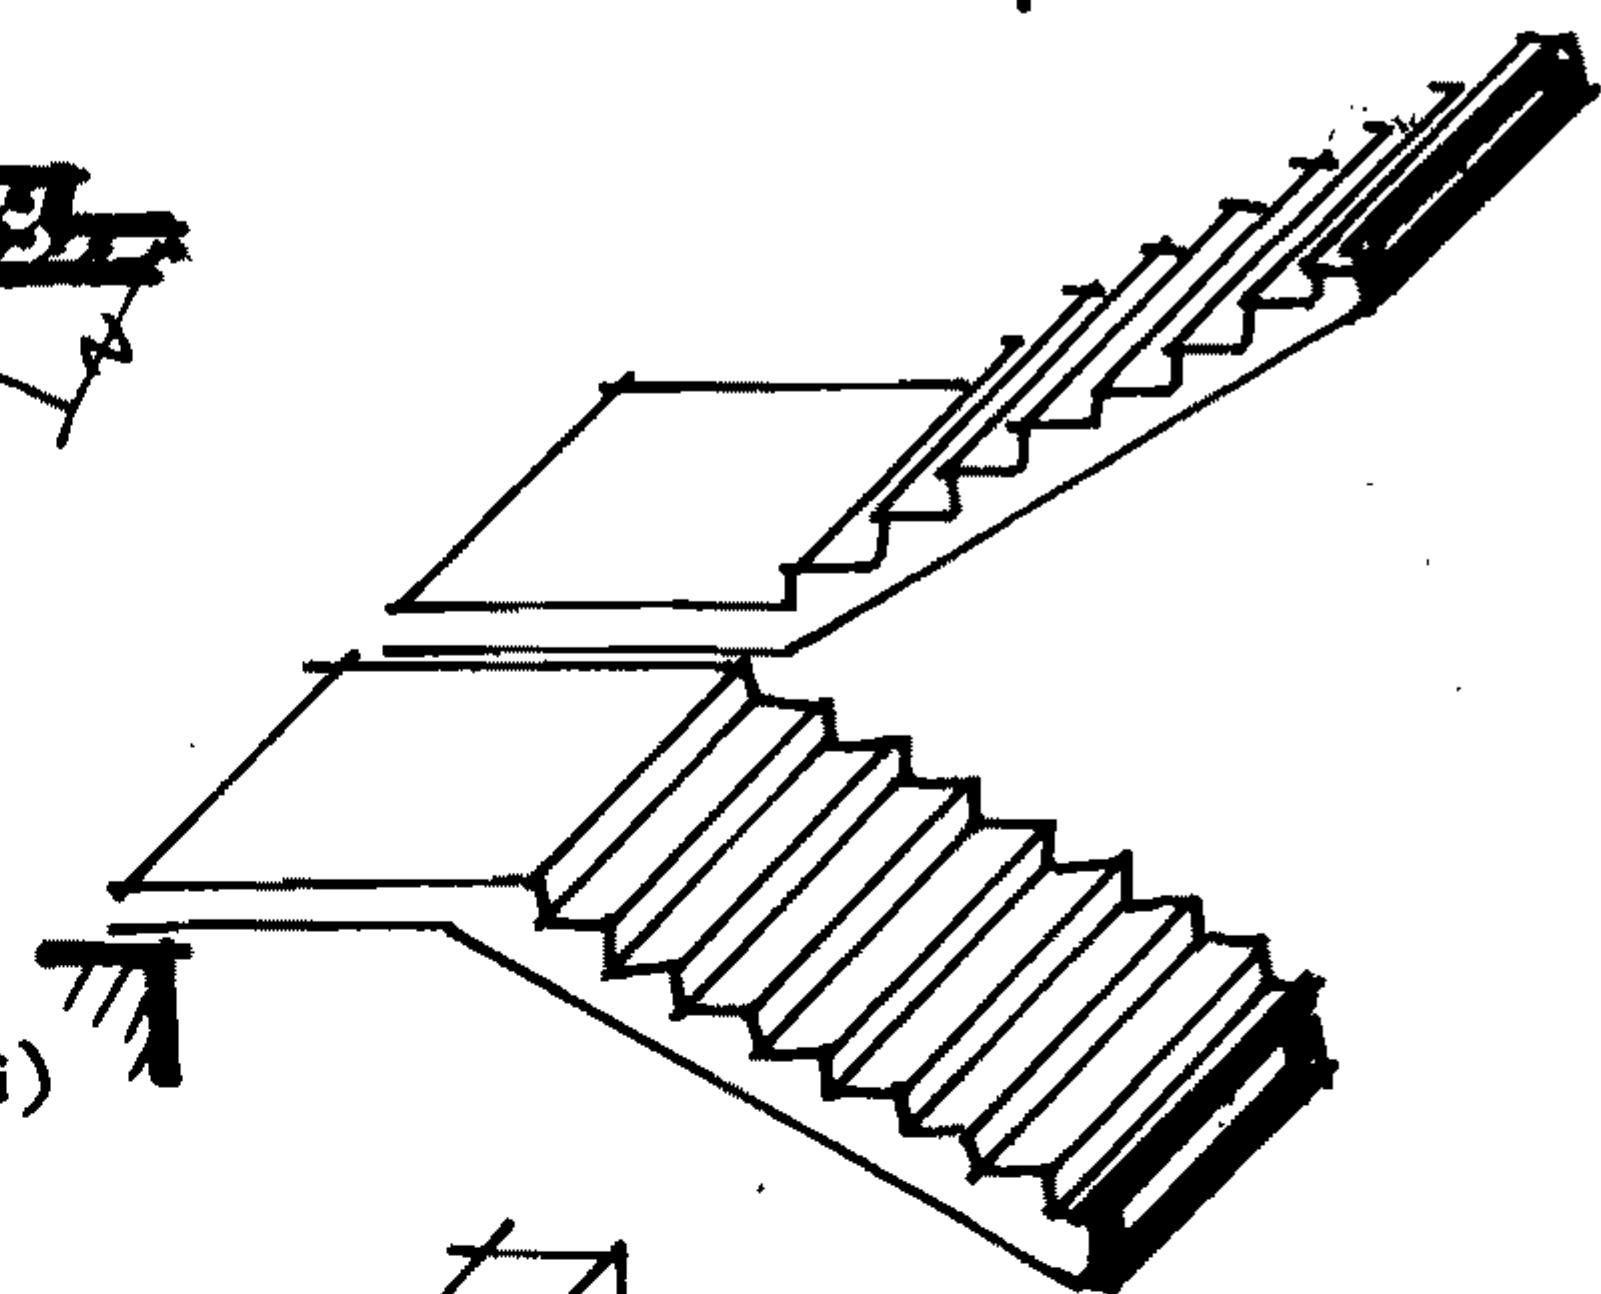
CẦU THANG LẮP GHÉP CẤU KIẾN TRUNG BÌNH
